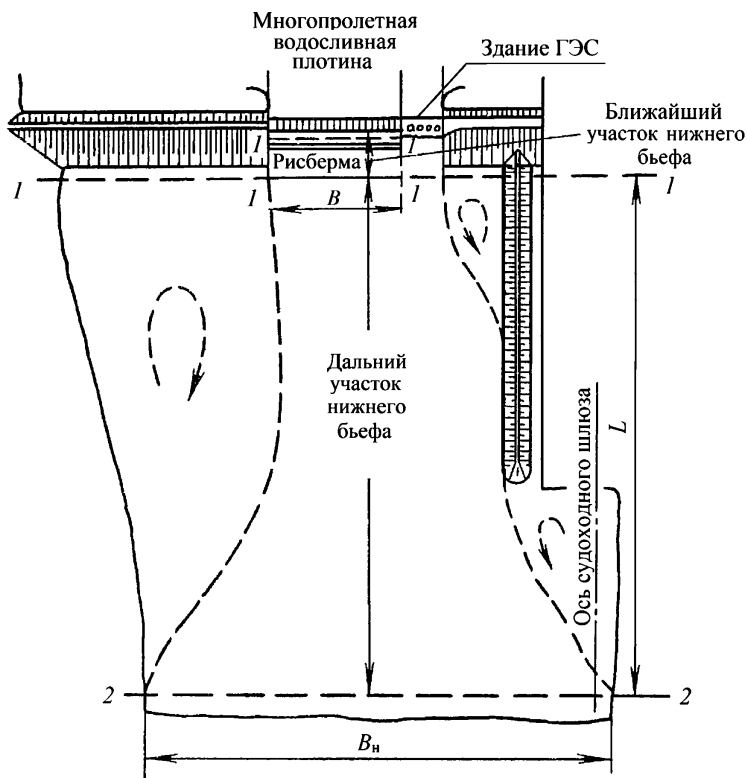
Схематический план нижнего бьефа гидроузла
